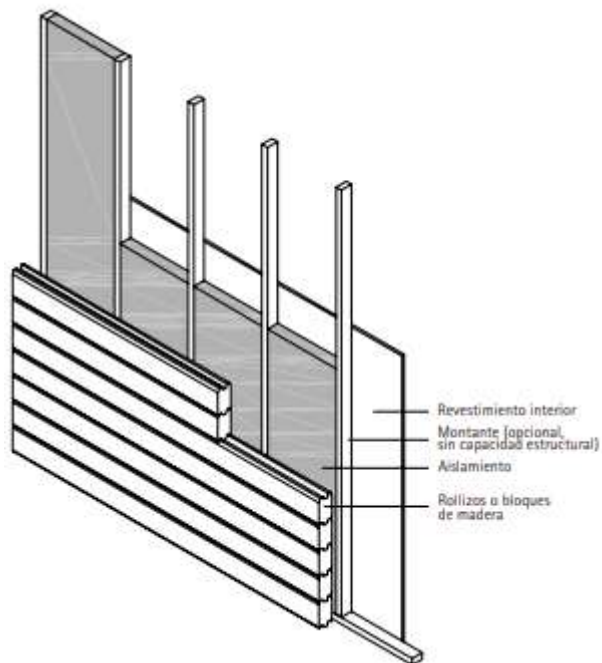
Sistema de vivienda con muros de troncos o de bloques de madera
